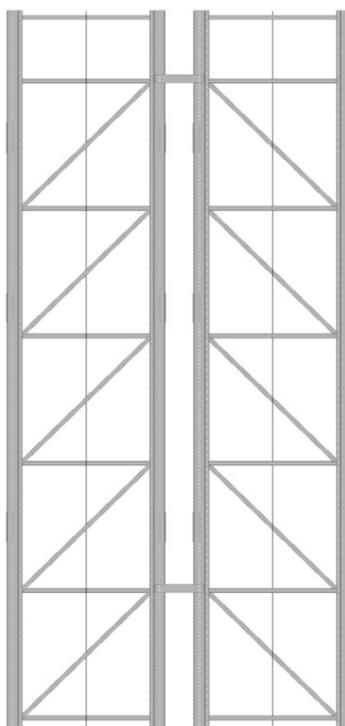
Abstandshalter mit Füllstabausfachung im M-Muster
